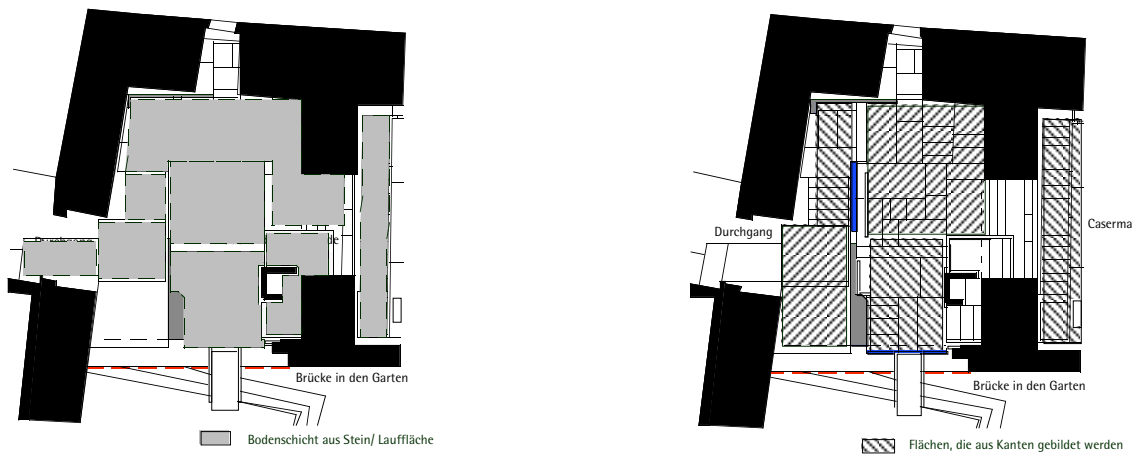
Raum des Cangrande, Obergeschoß, Grundriß
